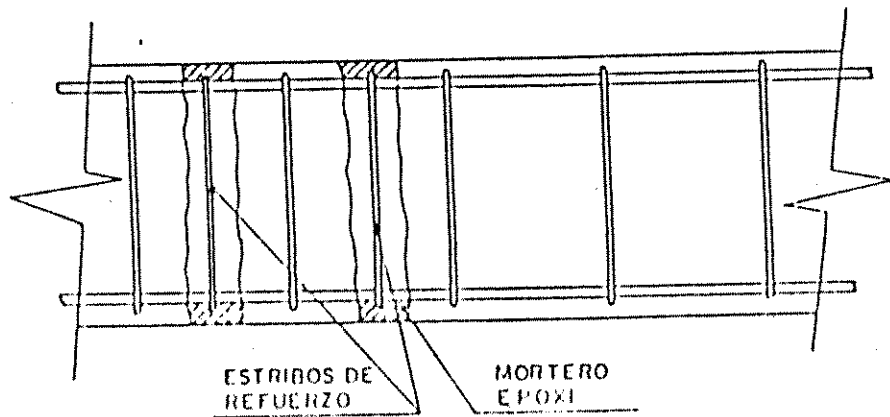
Refuerzo de una viga a cortante mediante estribos adiferenciados.
